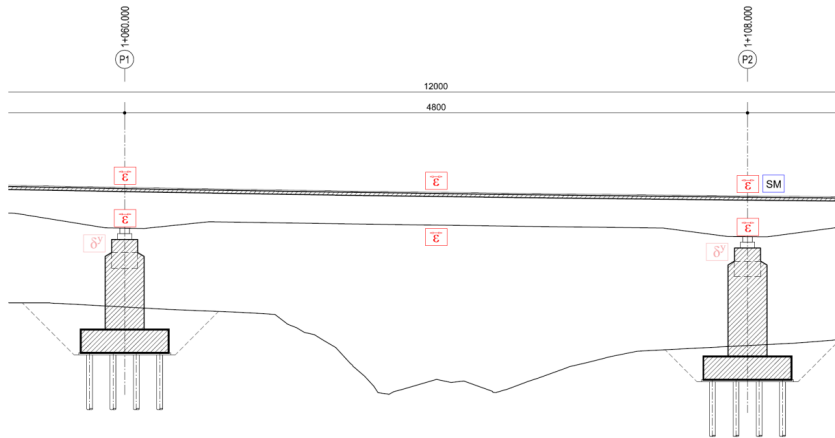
Ubicazione sensori su impalcato S. Antonio (sezione longitudinale campata centrale)
